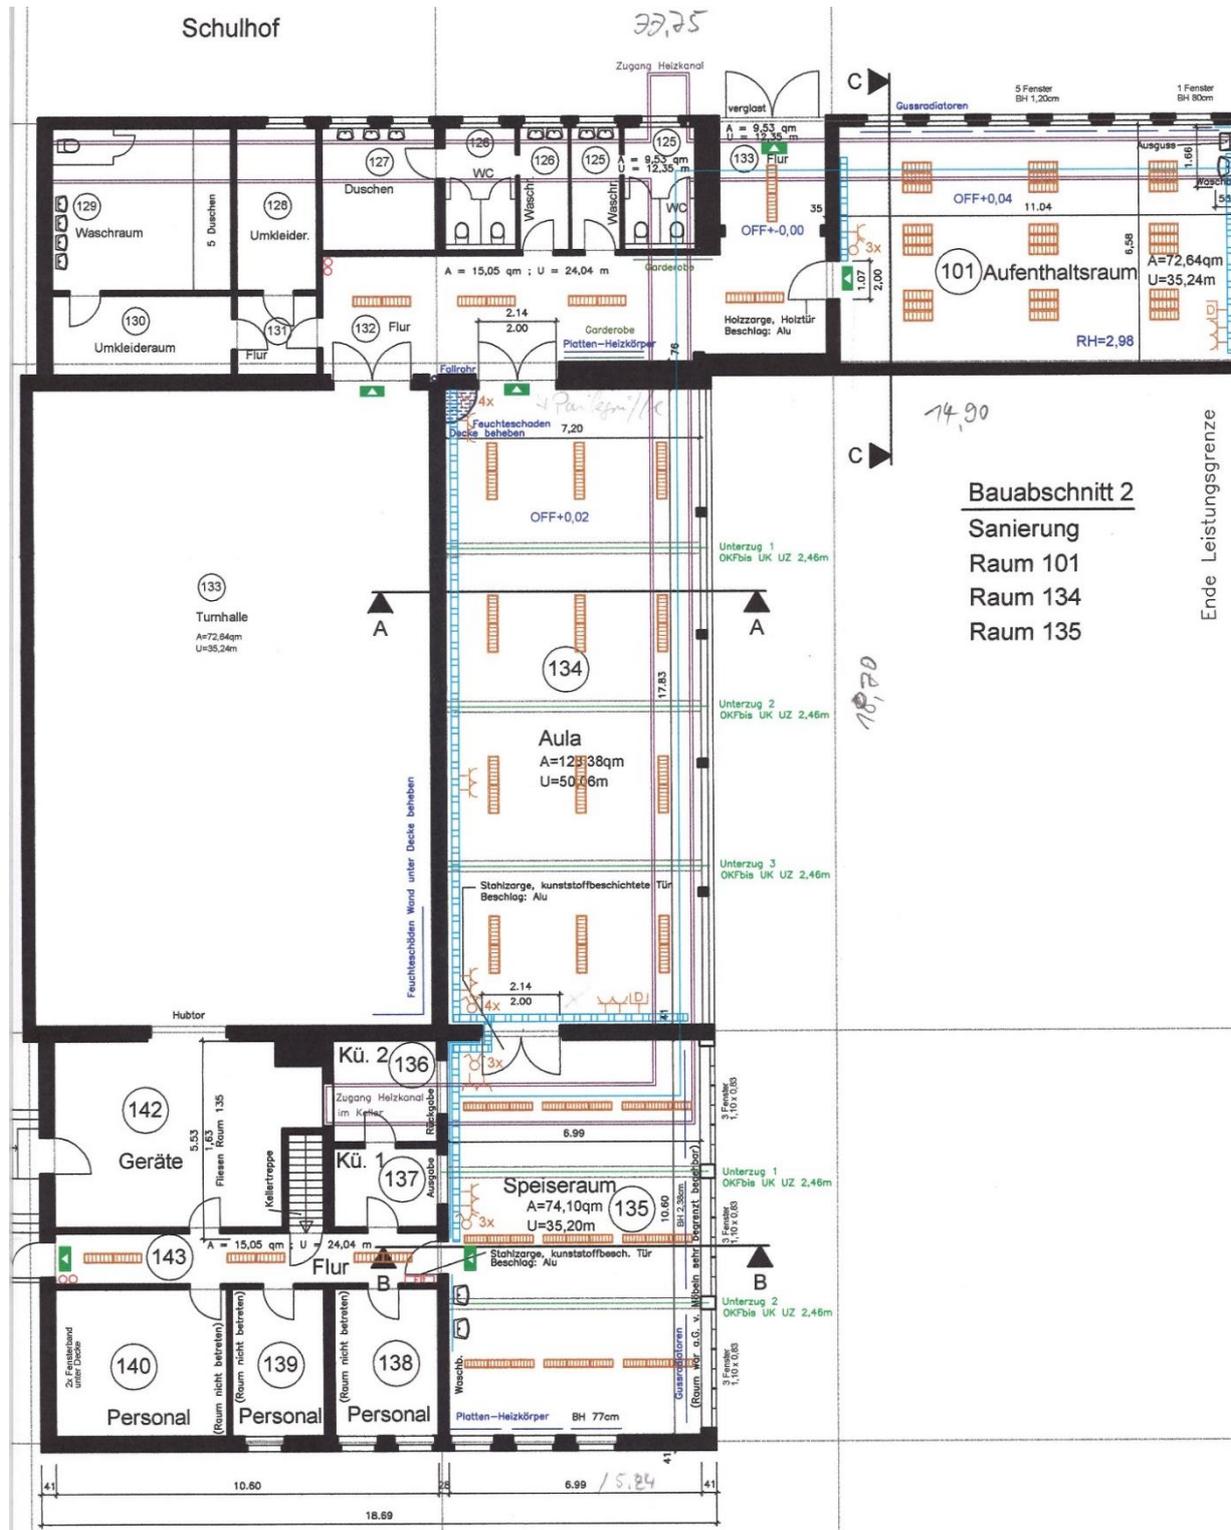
2. Bauabschnitt, Speiseraum, Aula, Werkraum
